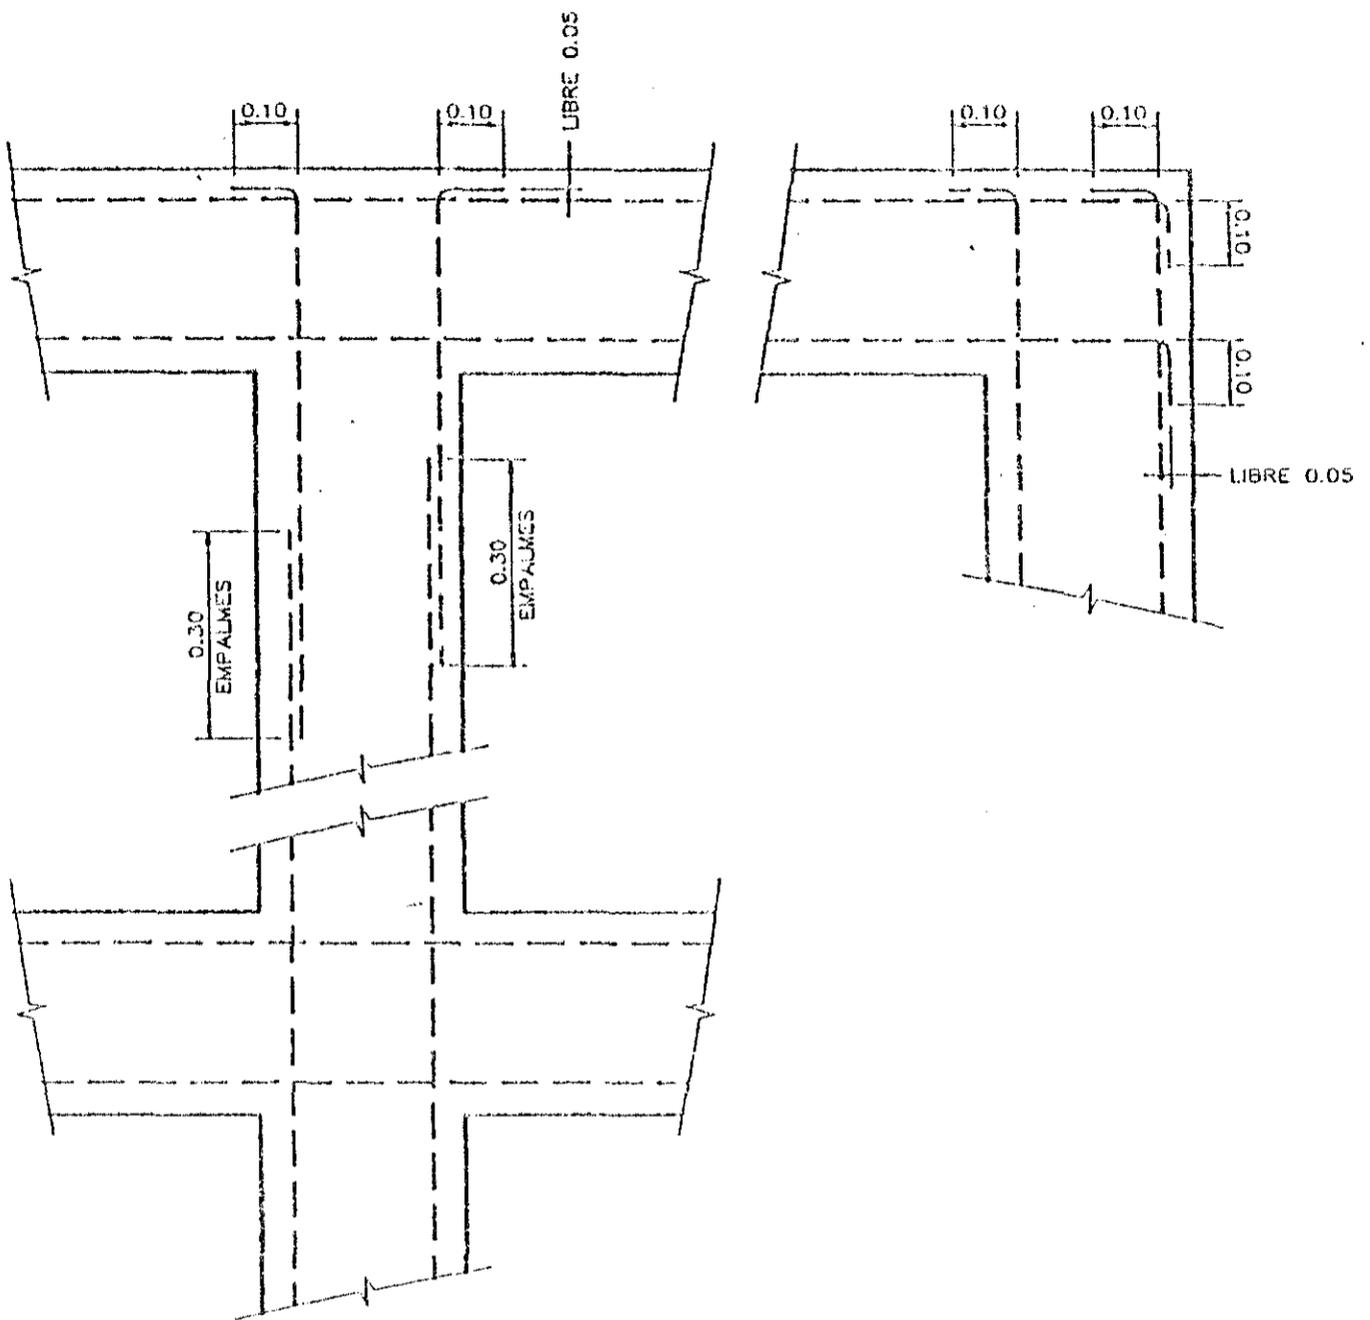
INTERSECCIONES EN PLANTA DE CIMIENTOS DE PAREDES
